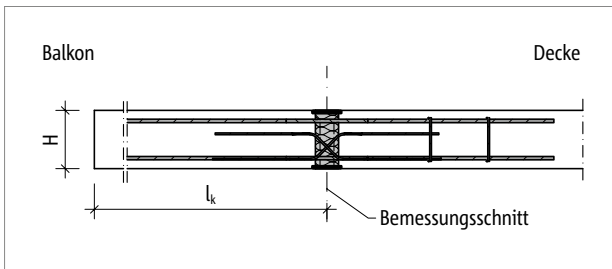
Schöck Isokorb® T Typ DP: Statisches System
